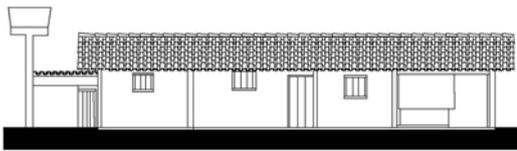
Fachada Norte (Acervo PROAU/FAU/UnB).
